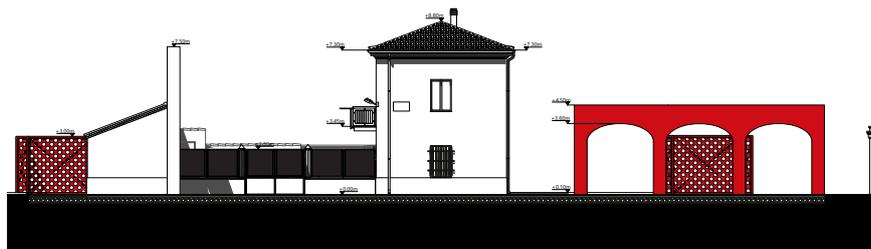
Prospetto est di progetto. Estratto della tavola 07_Prospetti e sezioni.
